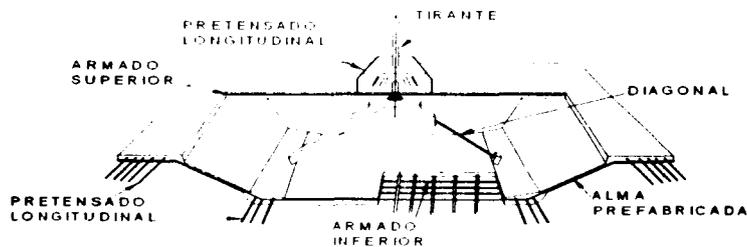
Sección transversal del puente Brotonne con el anclaje de los cables en el centro de la calzada
